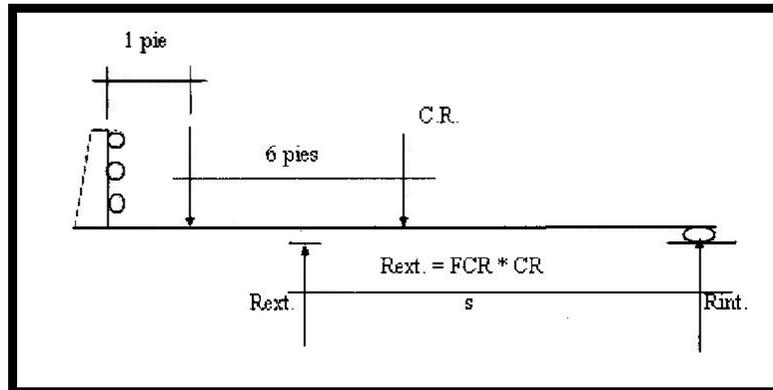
Condición II para el análisis de carga viva para viga externa.
